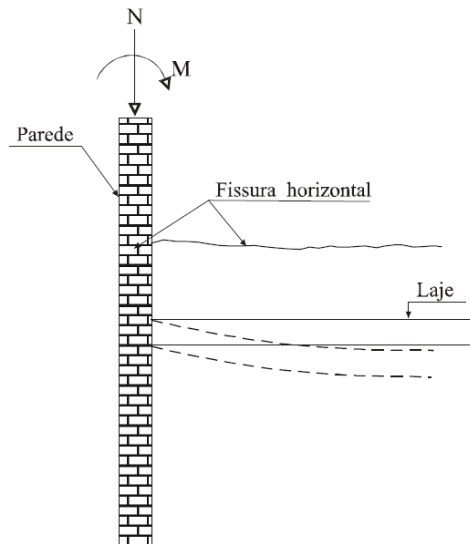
fissura em alvenaria devido à flecha excessiva em laje
